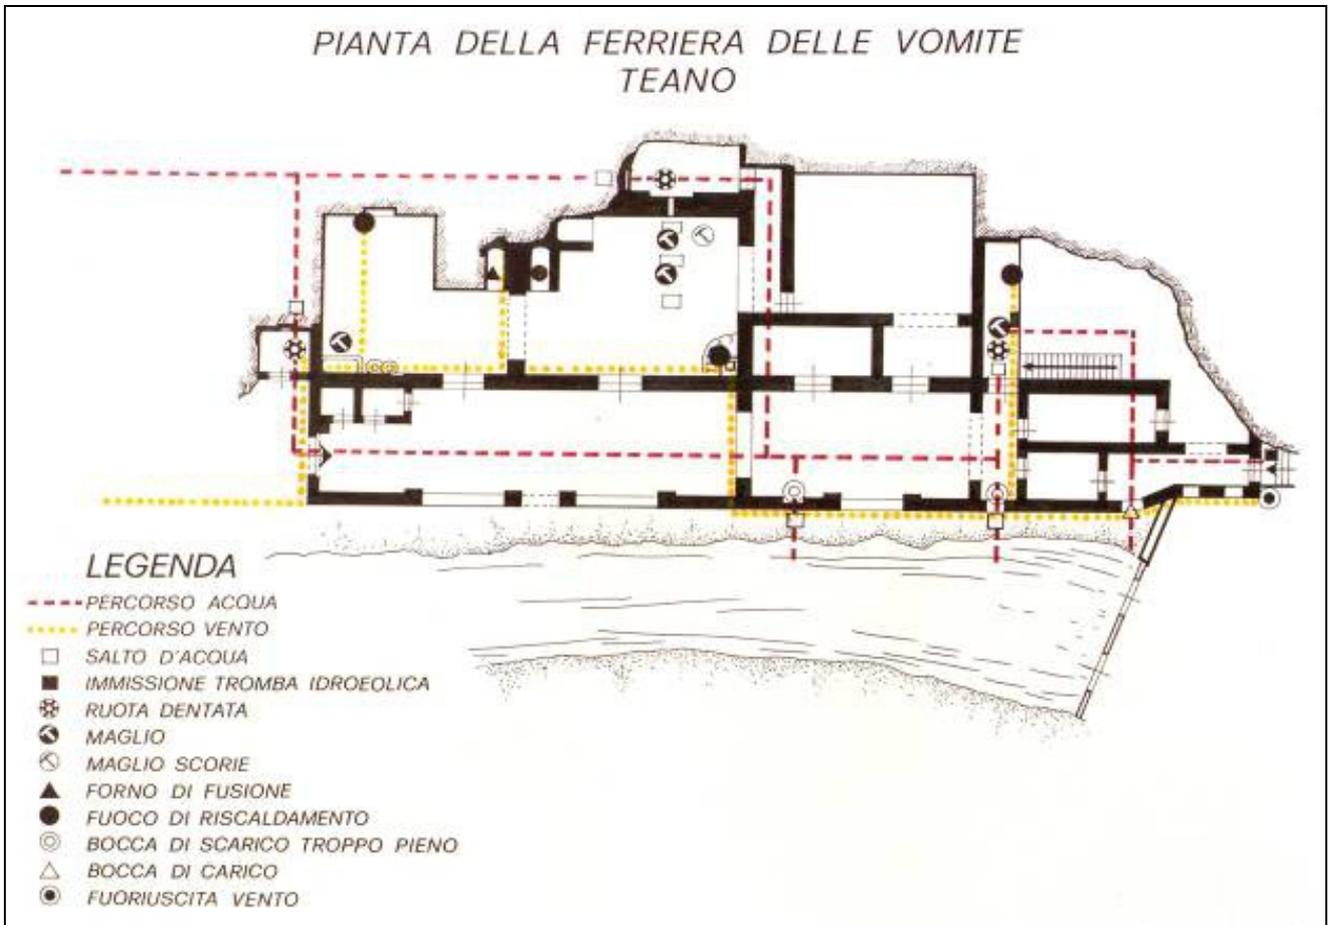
Schema degli impianti della ferriera (Archivio privato Salvi).
